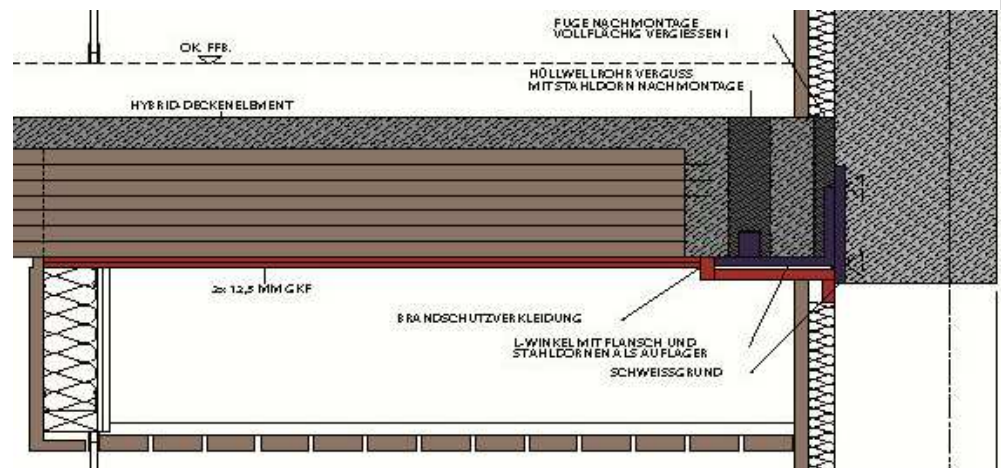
dettaglio della connessione orizzontamenti-vano scale
